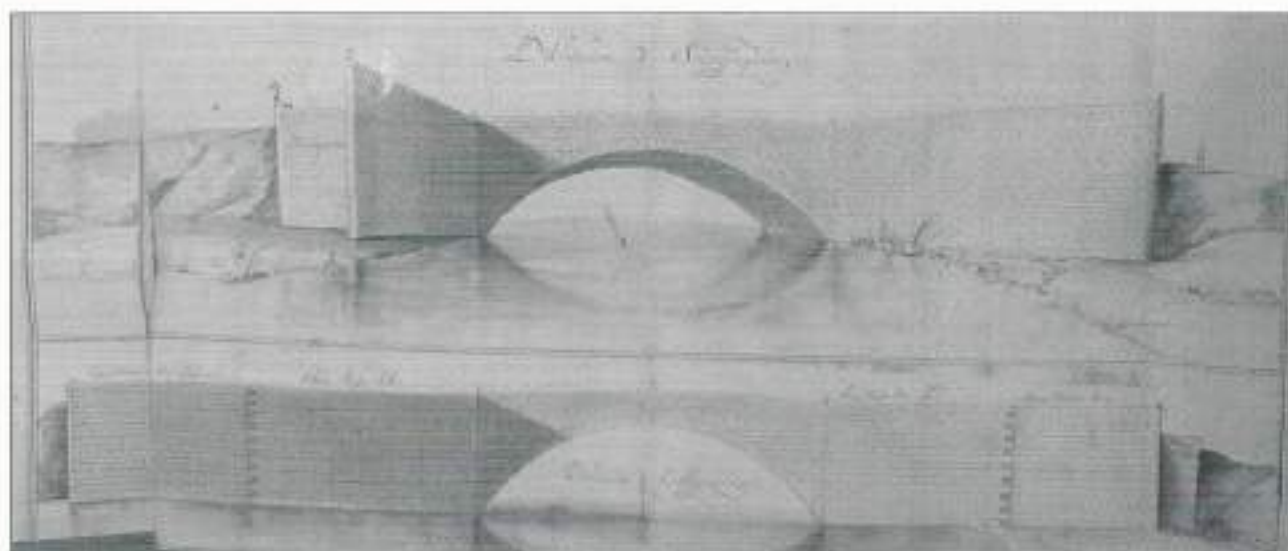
Proyecto del Puente de Levante 1740-45. Legajo F. 621, documento nº 2.
